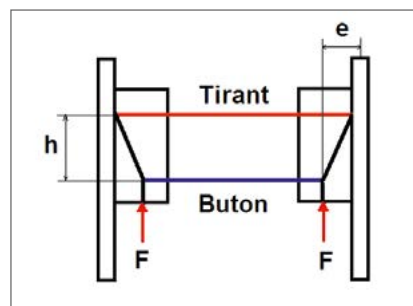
Fonctionnement en tirant-buton d'un massif d'ancrage (vue en plan)
